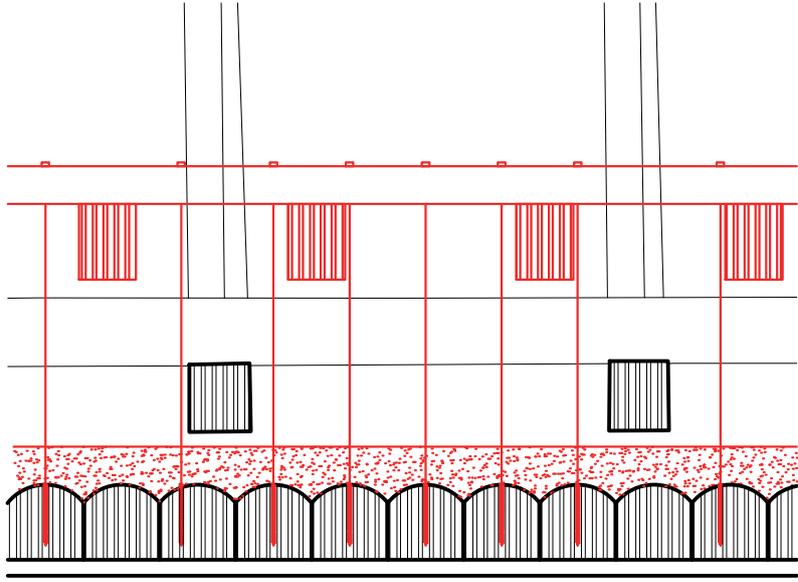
Vorschlag 3 zur Sanierung der Decke mit Polymerbeton und neuer Konstruktion zur Abhängung, Schnitt 2.
